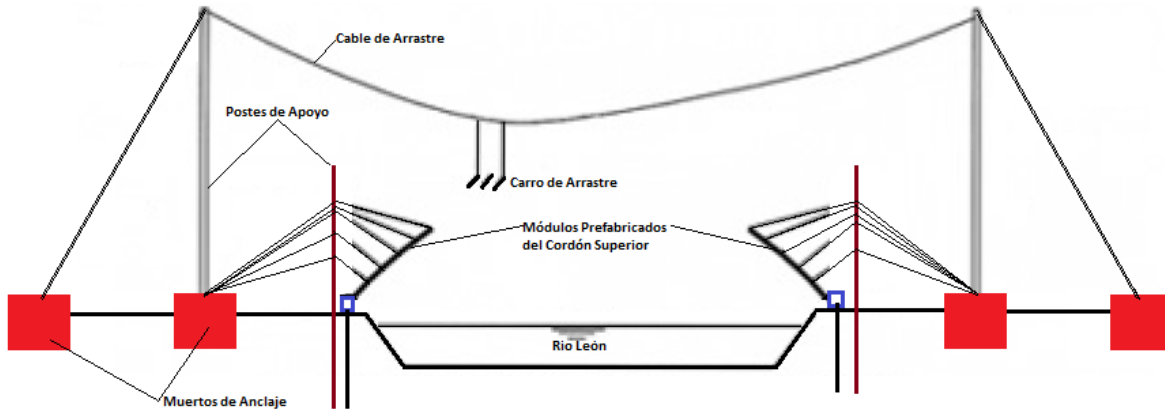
Alzado longitudinal montaje de elementos que componen el arco
